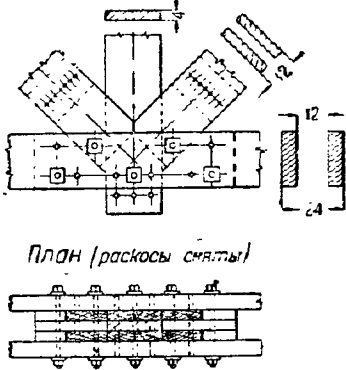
Средний узел нижнего пояса фермы с металлическими стойками и сопряжениями на вкладышах
